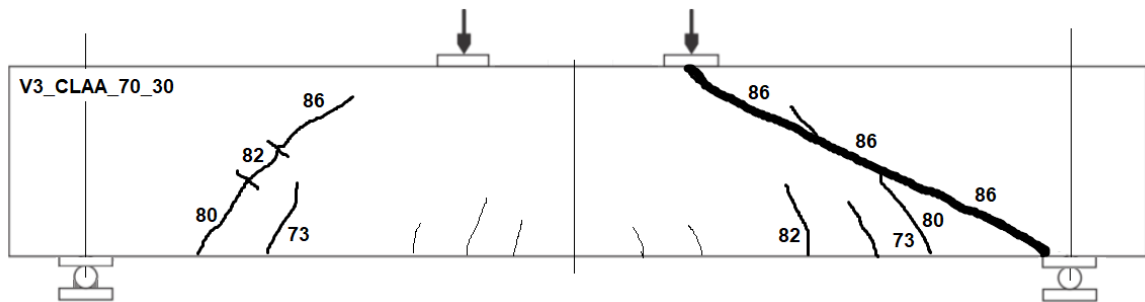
Esquema de fissuração da Viga 3_CLAA_70_30.
